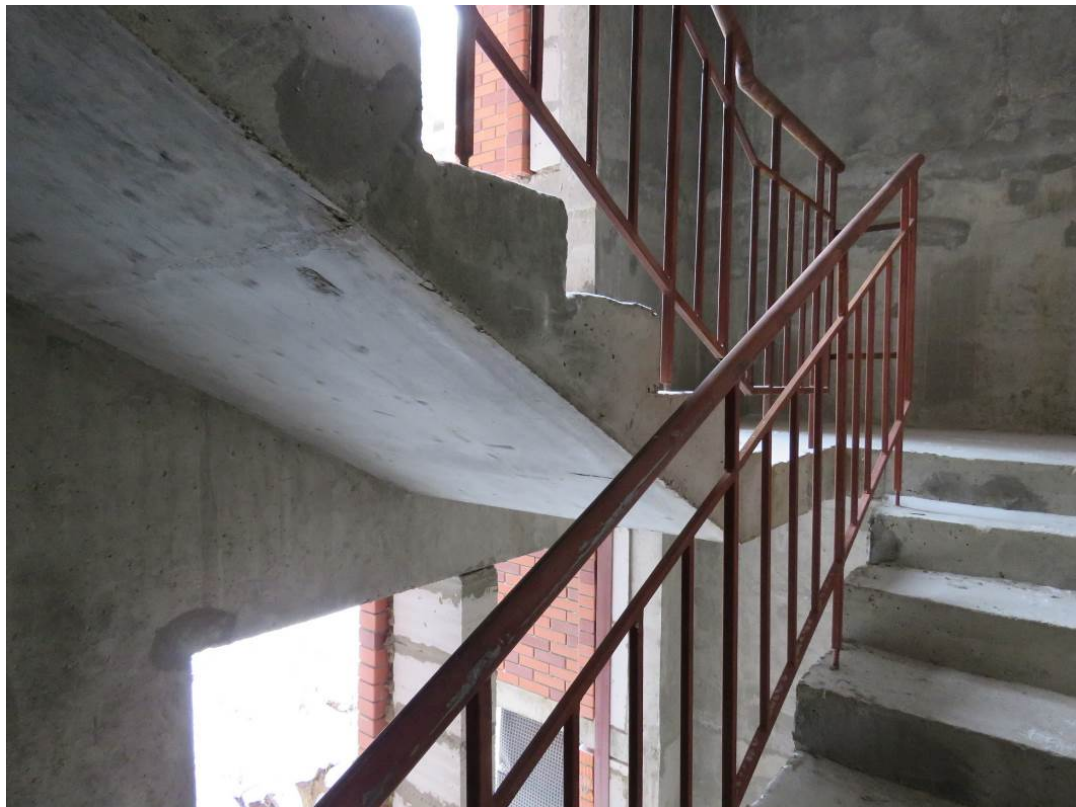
Общий вид лестничной клетки (монолитной железобетонной двухмаршевой лестницы) расположенной в уровне третьего этажа секции 4 расположенной между осями 6/4-8/4 и Г/4-Д/4 в уровне 1-го этажа
